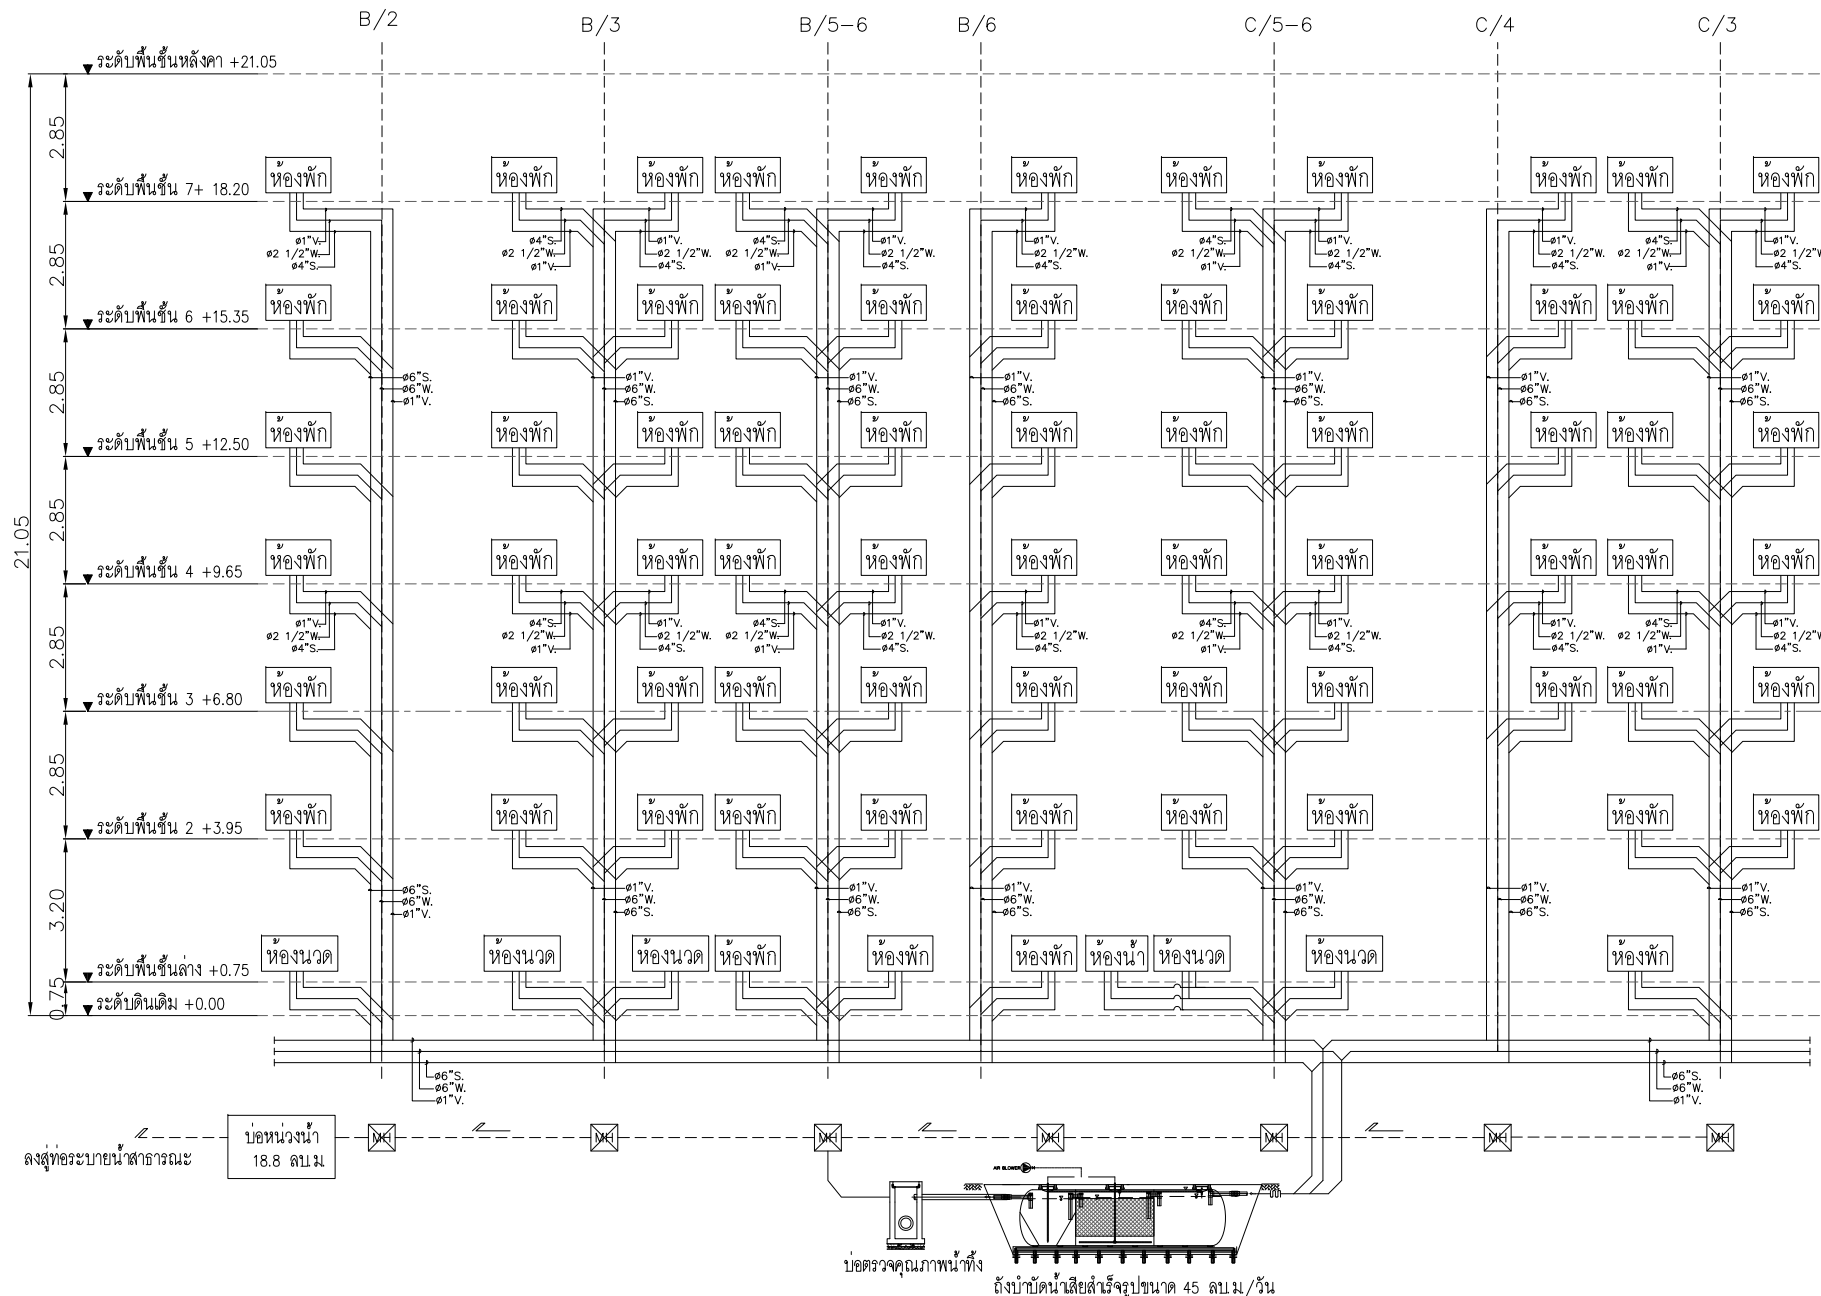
แผนผังระบบรวบรวมน้ำเสียของโครงการ
